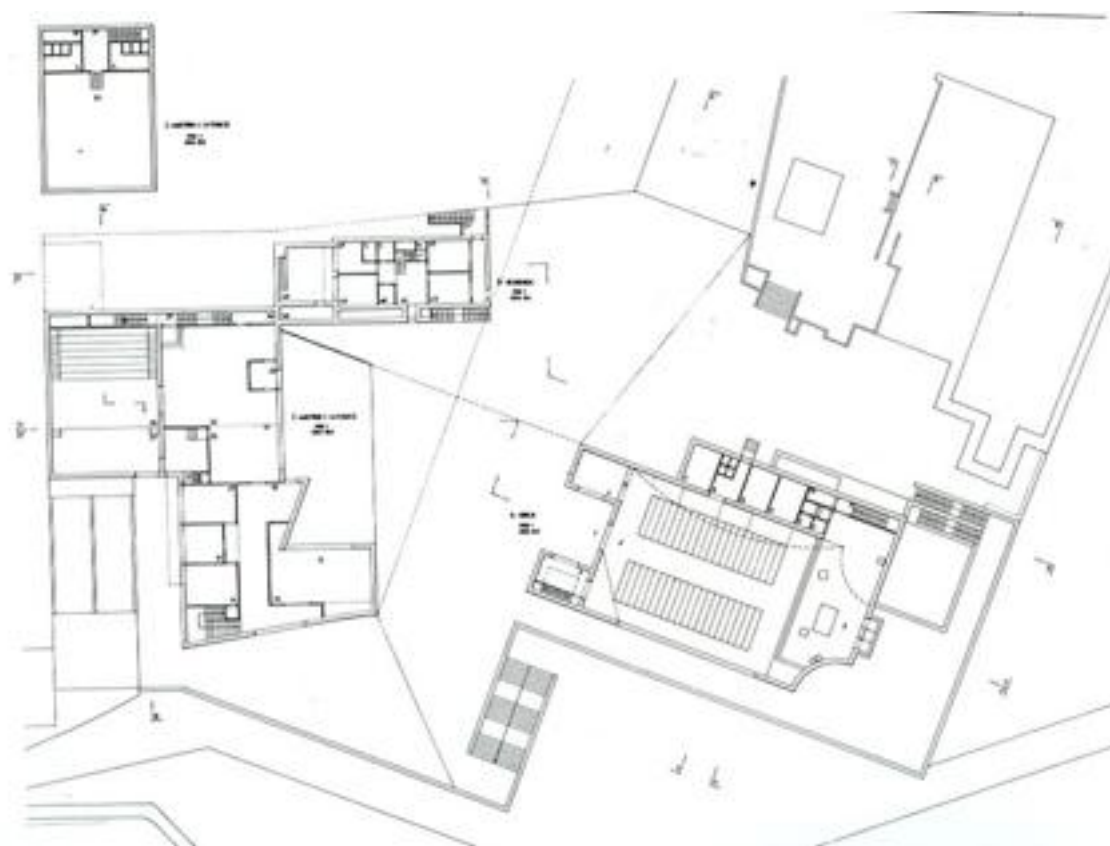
Plantas e cortes Igreja Santa Maria. ([Adaptado a partir de:] Arquivo fotográfico do site en.wikiarquitectura.com).
